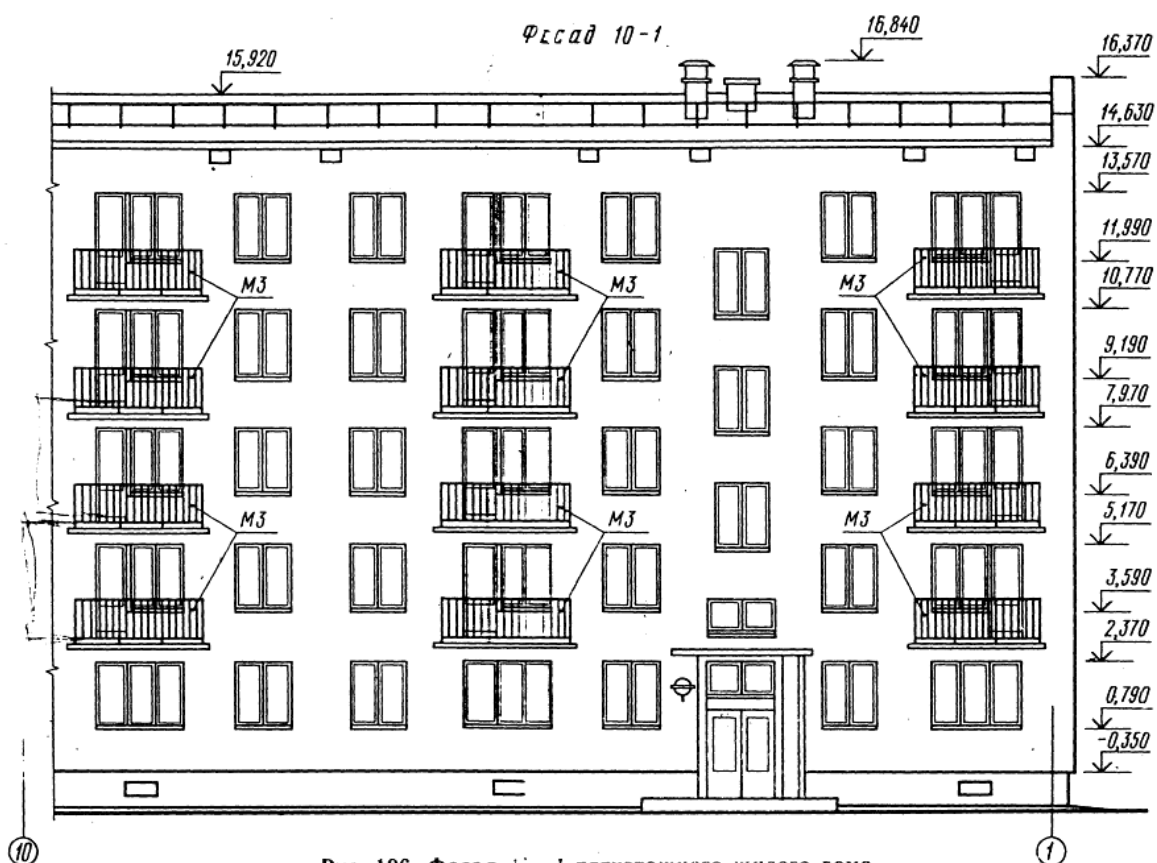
Фасад 10-1 — I пятиэтажного жилого дома
